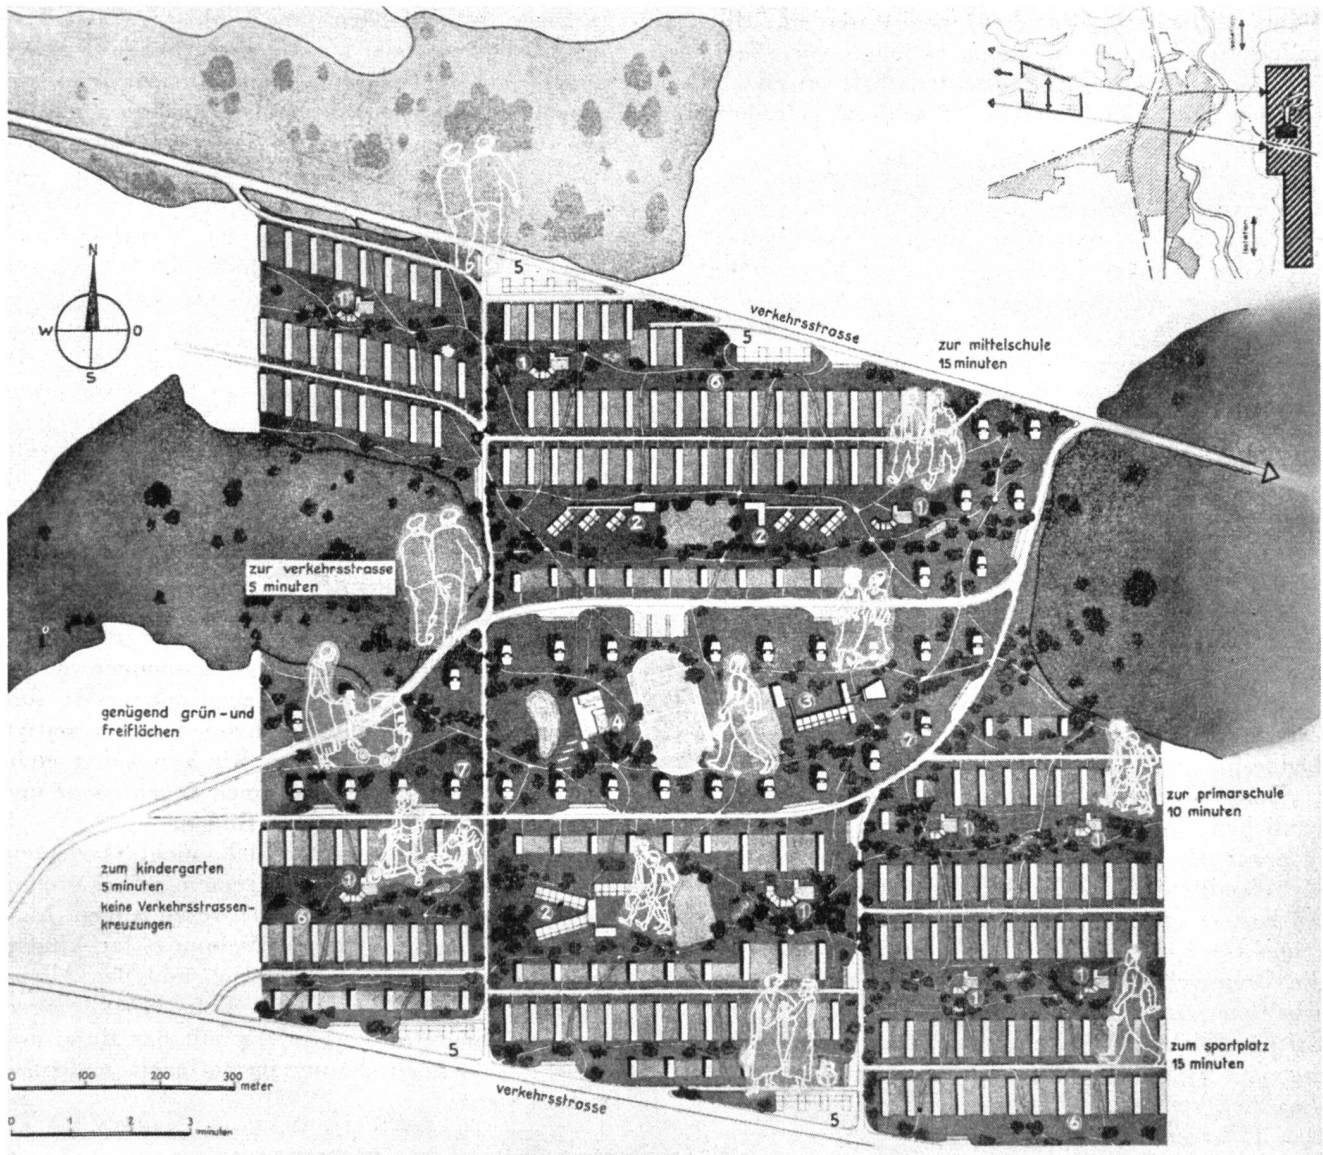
Projekt einer in sich geschlossenen Wohnsiedlung im Anschluss an den Stadtkern einer Großstadt. Wohnbauten in Zeilenbau für die Familien. Hochhäuser mit kleinen Wohnungen für die Alleinstehenden und Kinderlosen. 1 Kindergarten, 2 Primarschule, 3 Mittelschule, 4 Volkshaus mit Schwimmbad, 5 Ladenbauten, 6 zweigeschossige Reihenhäuser, 7 zehngeschossige Hochhäuser (aus „Weiterbauen“ Nr. 2, November 1934).
